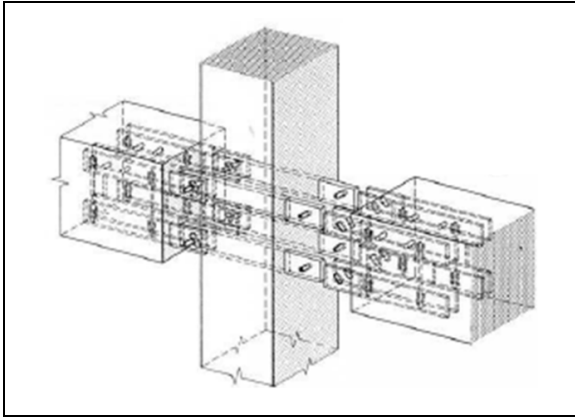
Ligação por chapas metálicas soldadas com betonagem *in situ* (Stupré, 1981)
